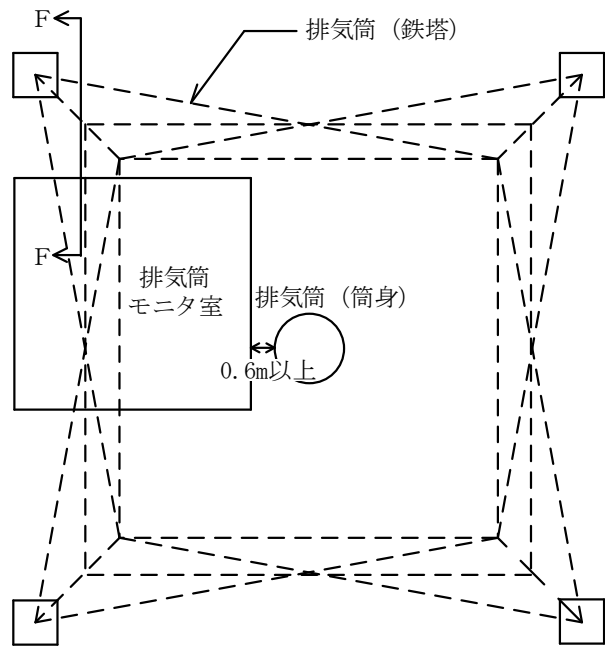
(2) 建物配置図 (排気筒モニタ室及び排気筒の詳細)
